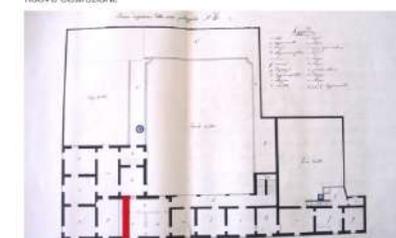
Il salone che prima collegava le due parti del palazzo, diviso nella seconda metà dell'800.
